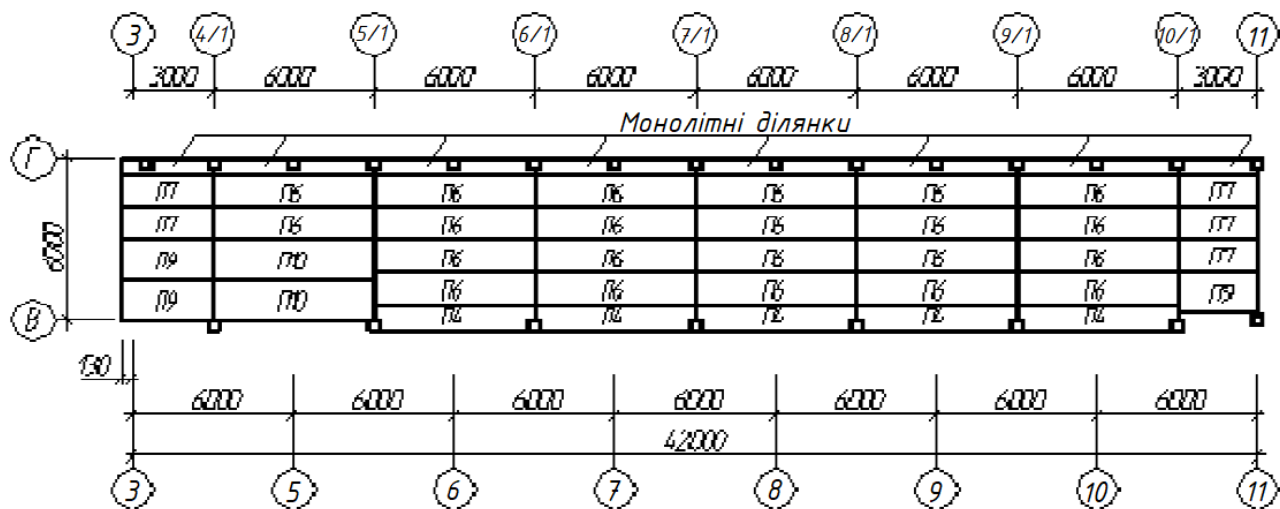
Схема розташування плит перекриття на відм. +4,430м.
